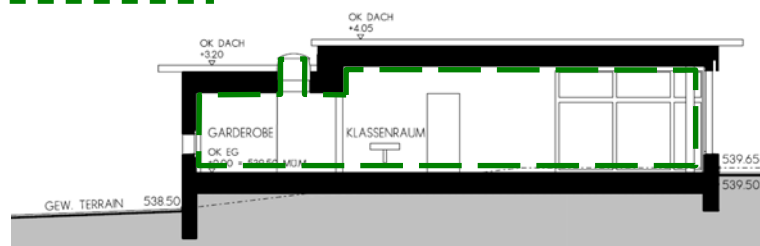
Section avec niveau d'étanchéité à l'air inscrit
